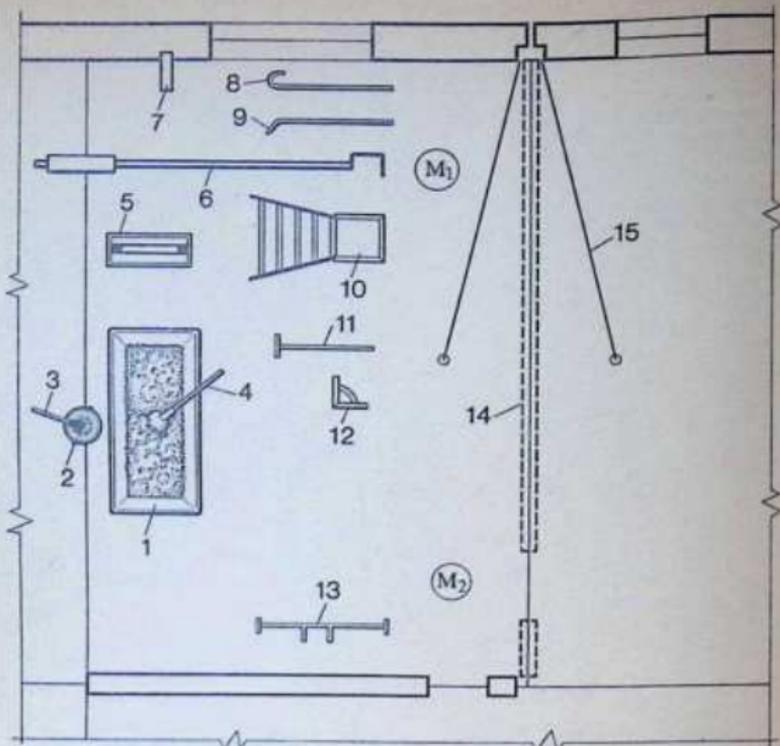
Схема организации рабочего места при монтаже панели-перегородки:
